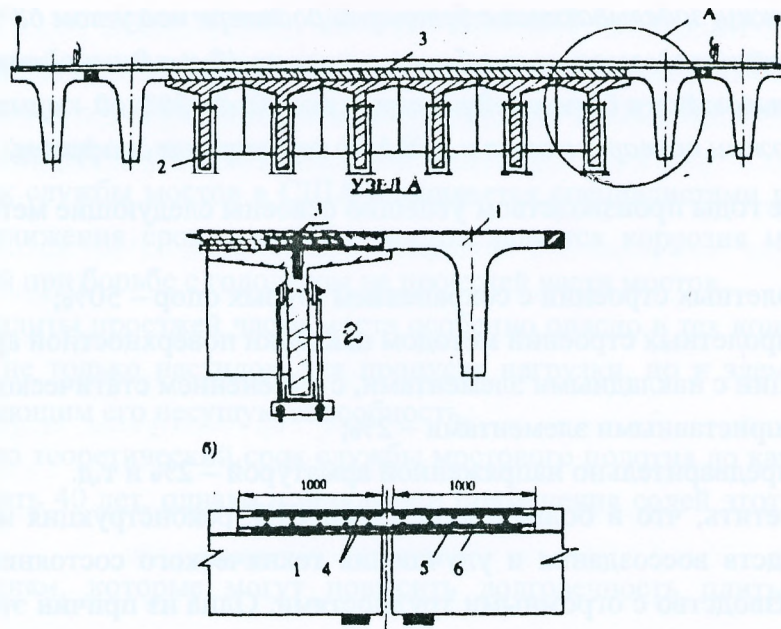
Комплексное уширение и усиление пролетных строений: 1 – балка приставная; 2 – наклейка поверхностной арматуры; 3 – плита усиления; 4,5,6 – арматура.
